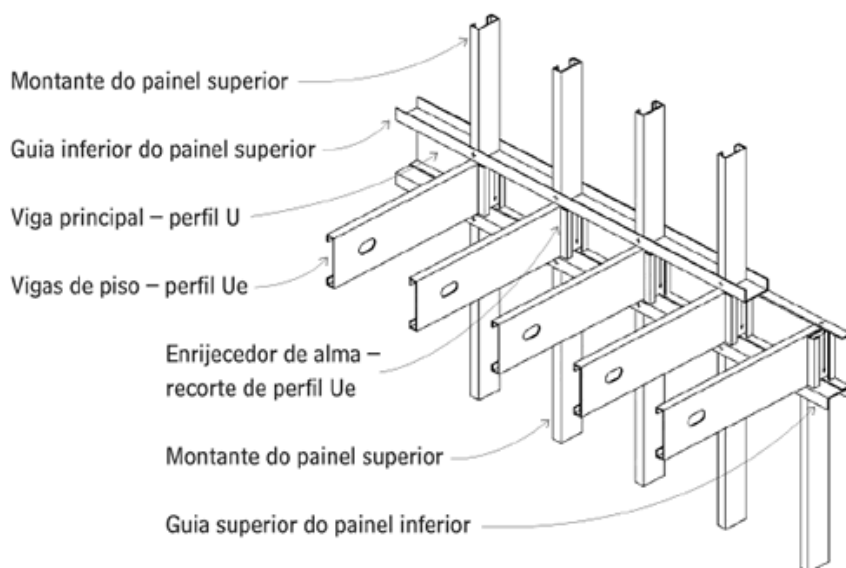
Vigas de piso e montantes de uma laje em LSF.
